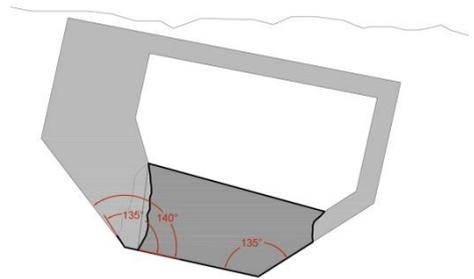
Propuesta de planta hexagonal “en proa” para la Torreta.
